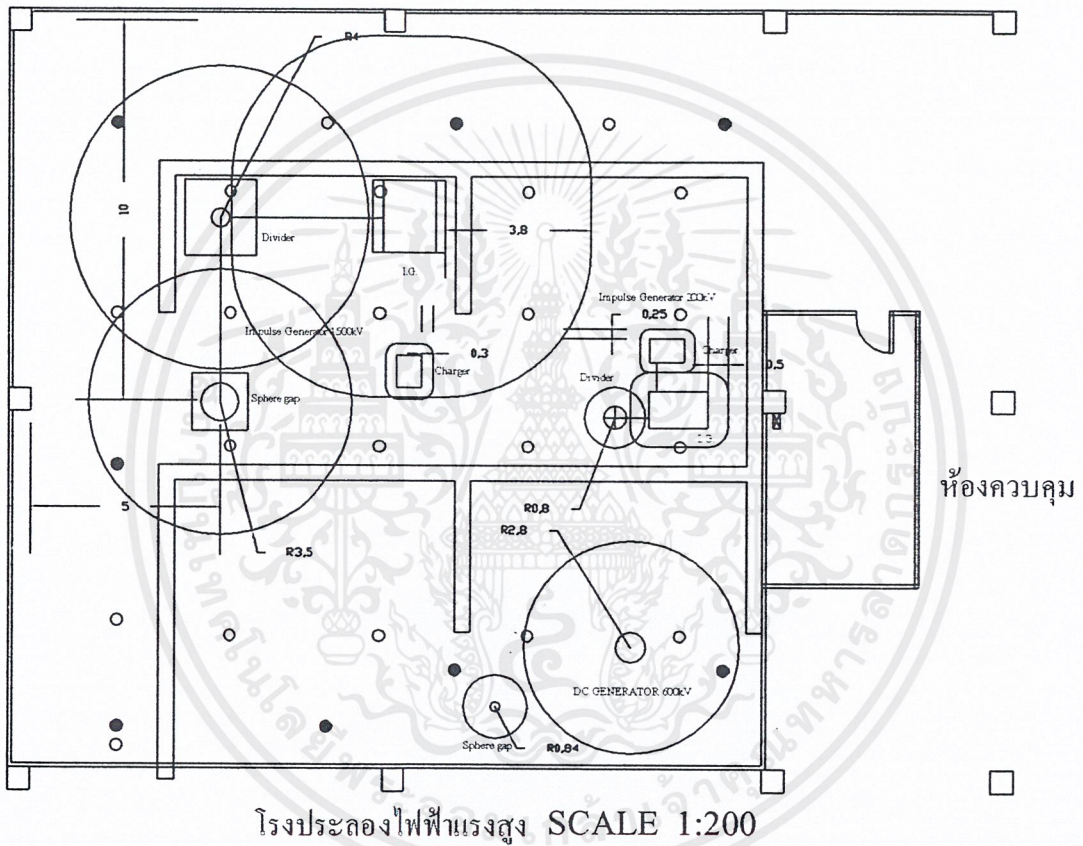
แสดง Floor plan โรงประดองไฟฟ้าแรงสูง
